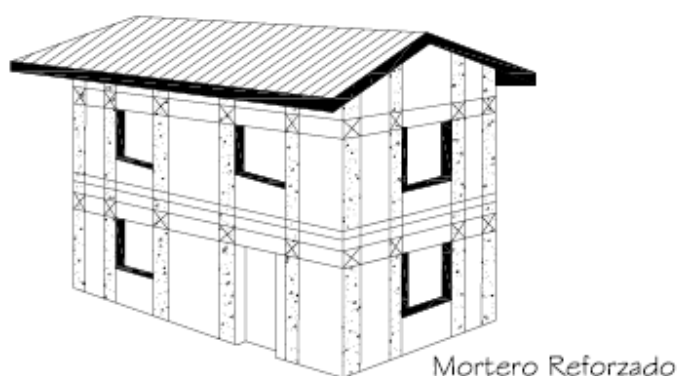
Confinamiento de muros de mampostería con fajas de mortero reforzado.
